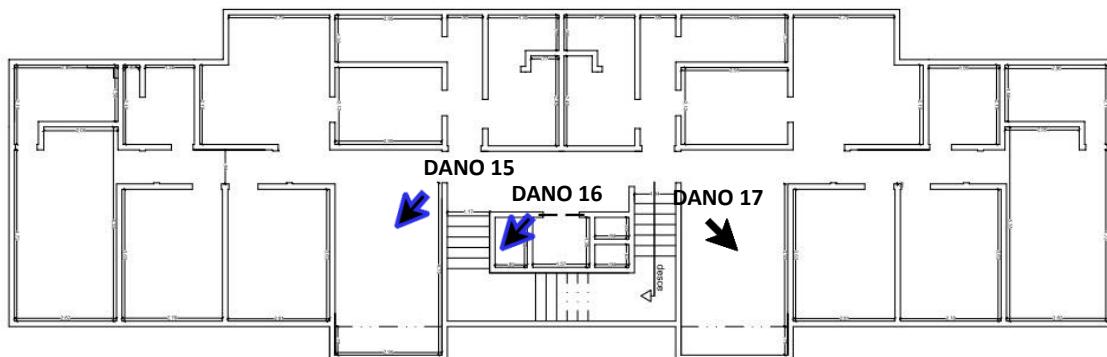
Planta Baixa (croqui) – Pavimento do 6º andar – Bloco B – Cond. Armando Lôbo.
